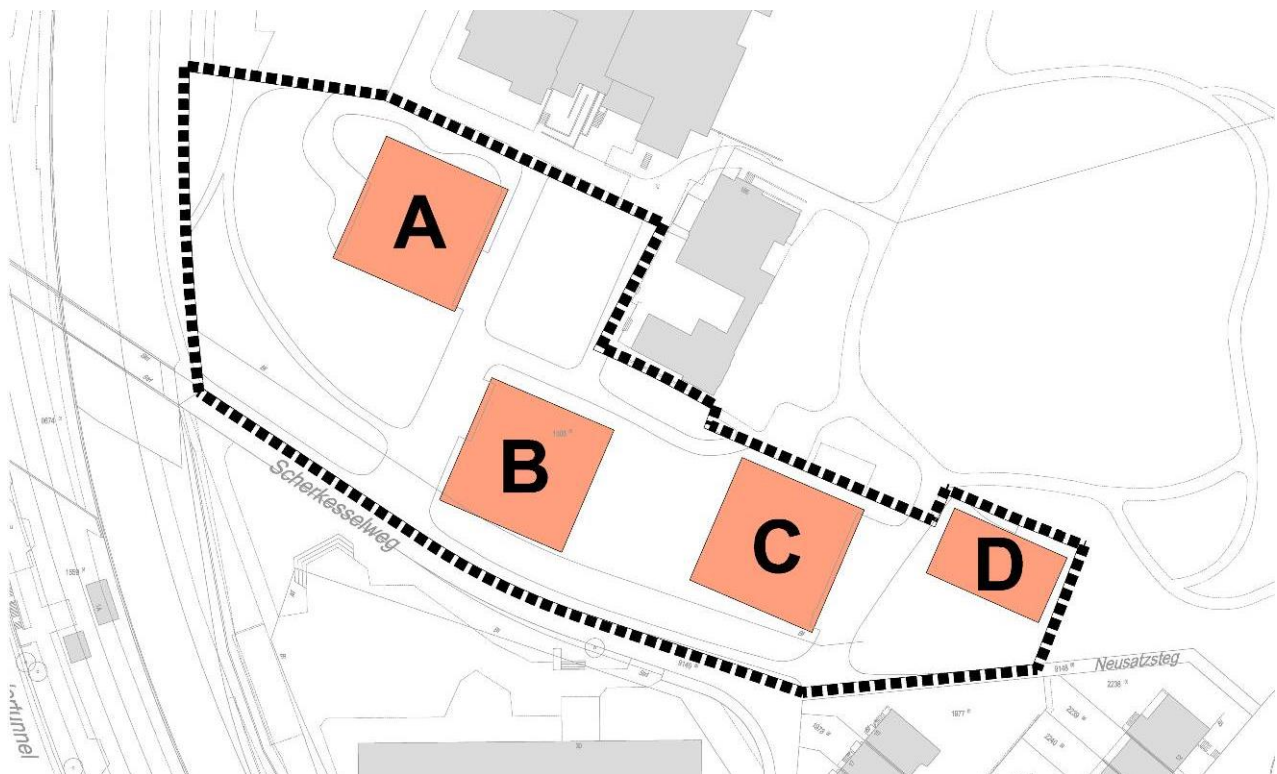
Entwurf neuer Bebauungsplan Nr. 13'927
